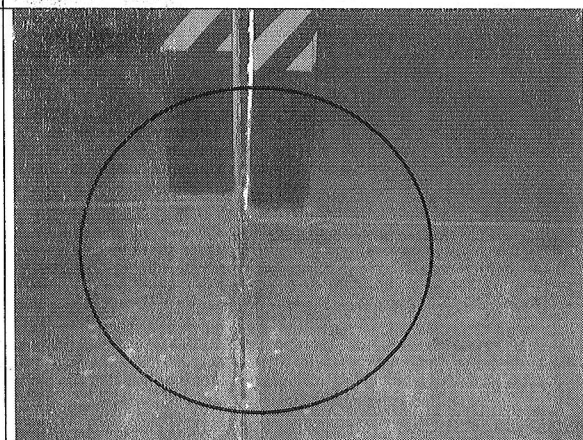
Fisuras en la placa de piso del semisótano.
